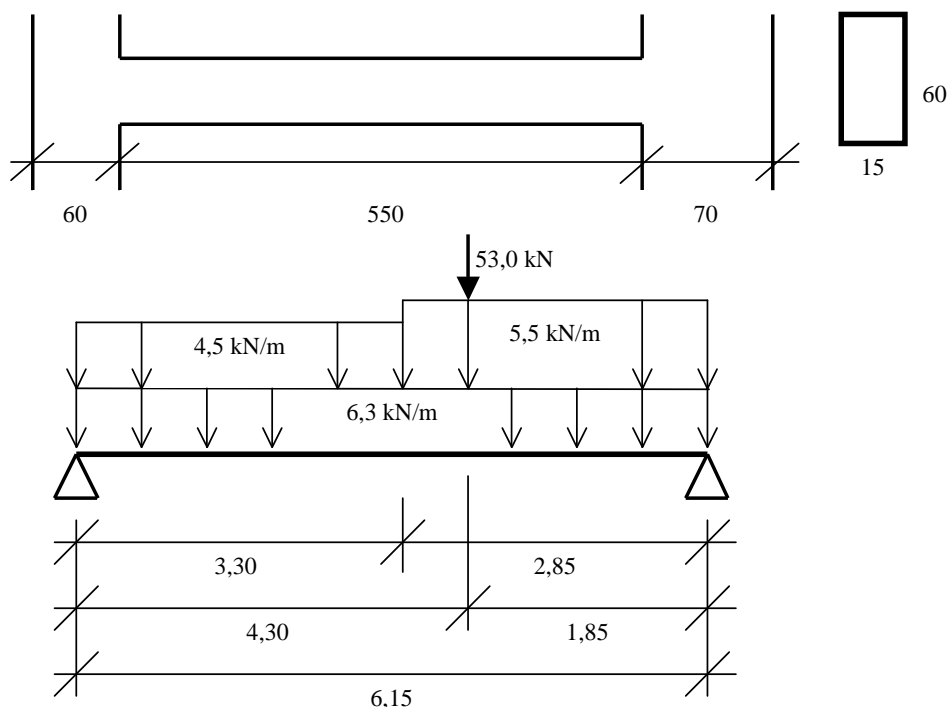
Dimensões e Carregamentos da Viga do Exemplo 1. (SEELBACH (2004))
